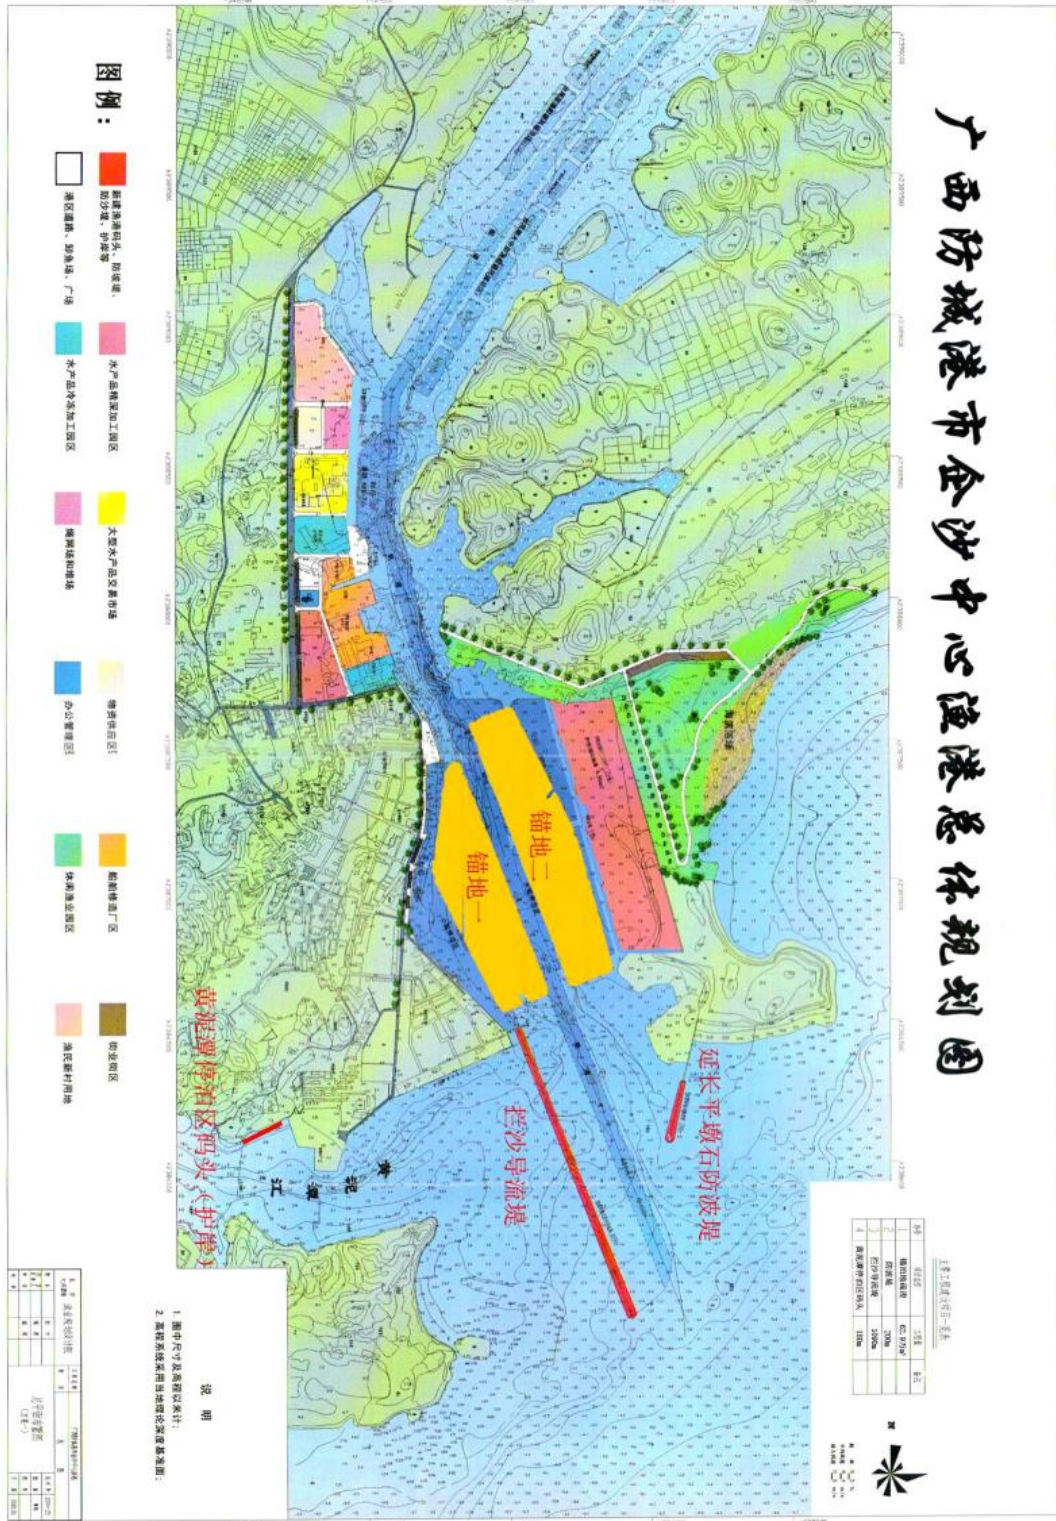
防城港市企沙中心渔港工程总平面布置图
